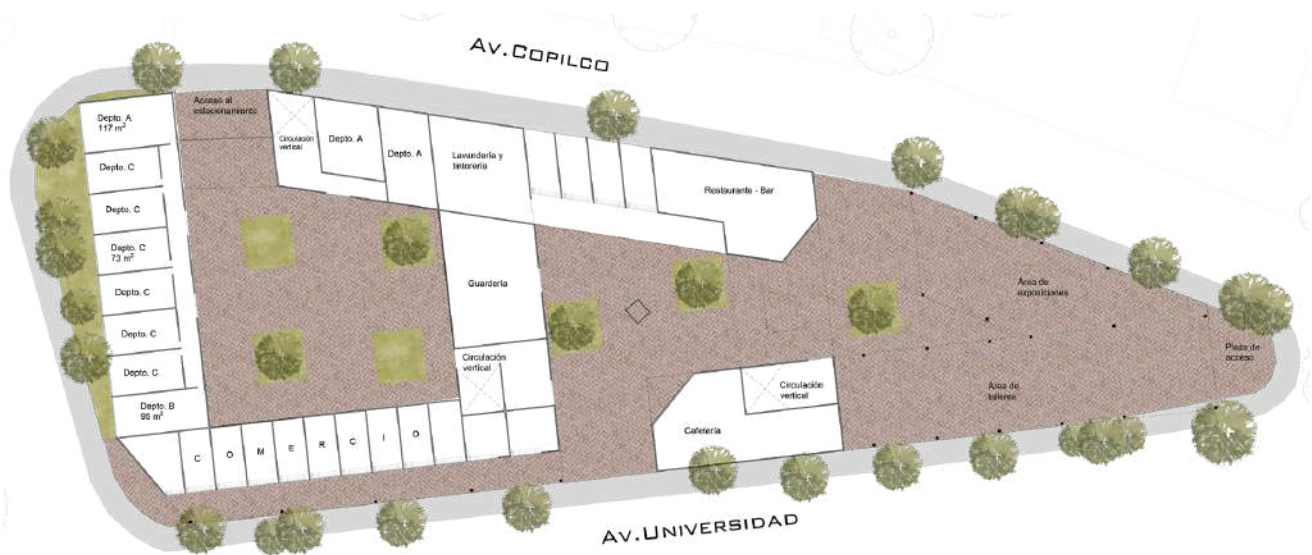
Planta baja ambientada. Fuente: Autoría propia.
